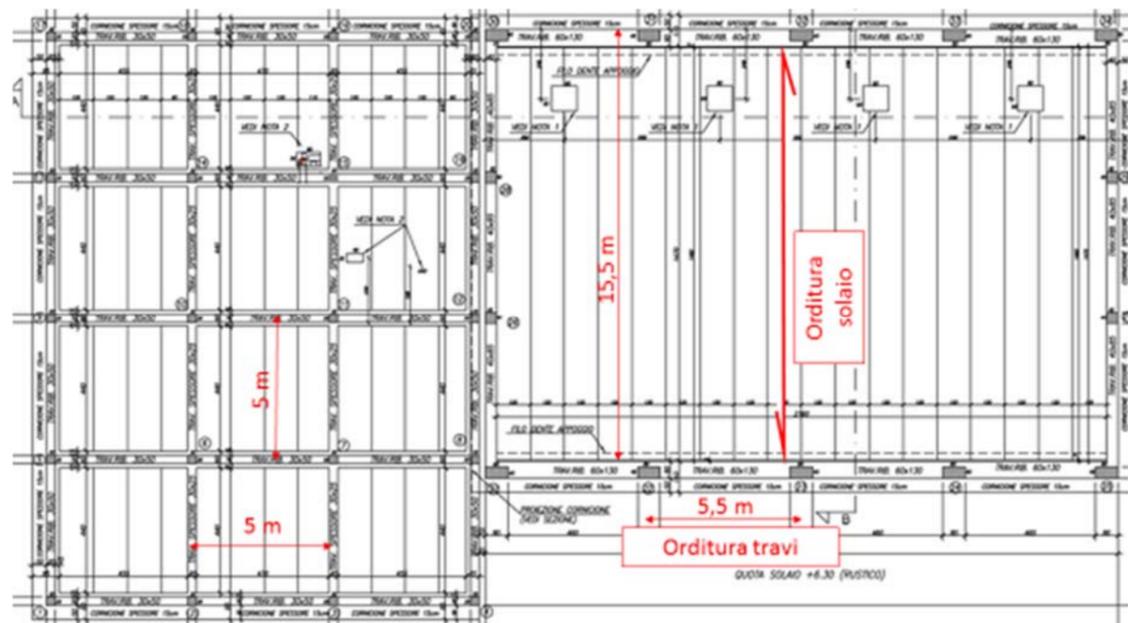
Vista in pianta dell'orditura della stazione VV.FF
